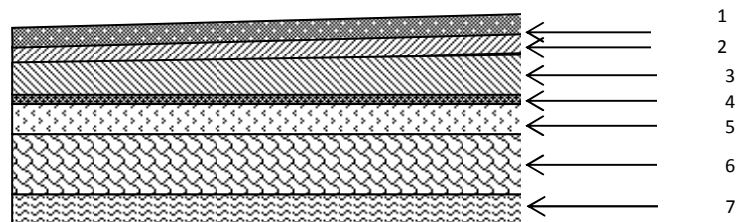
Coupe transversale du plancher terrasse inaccessible
